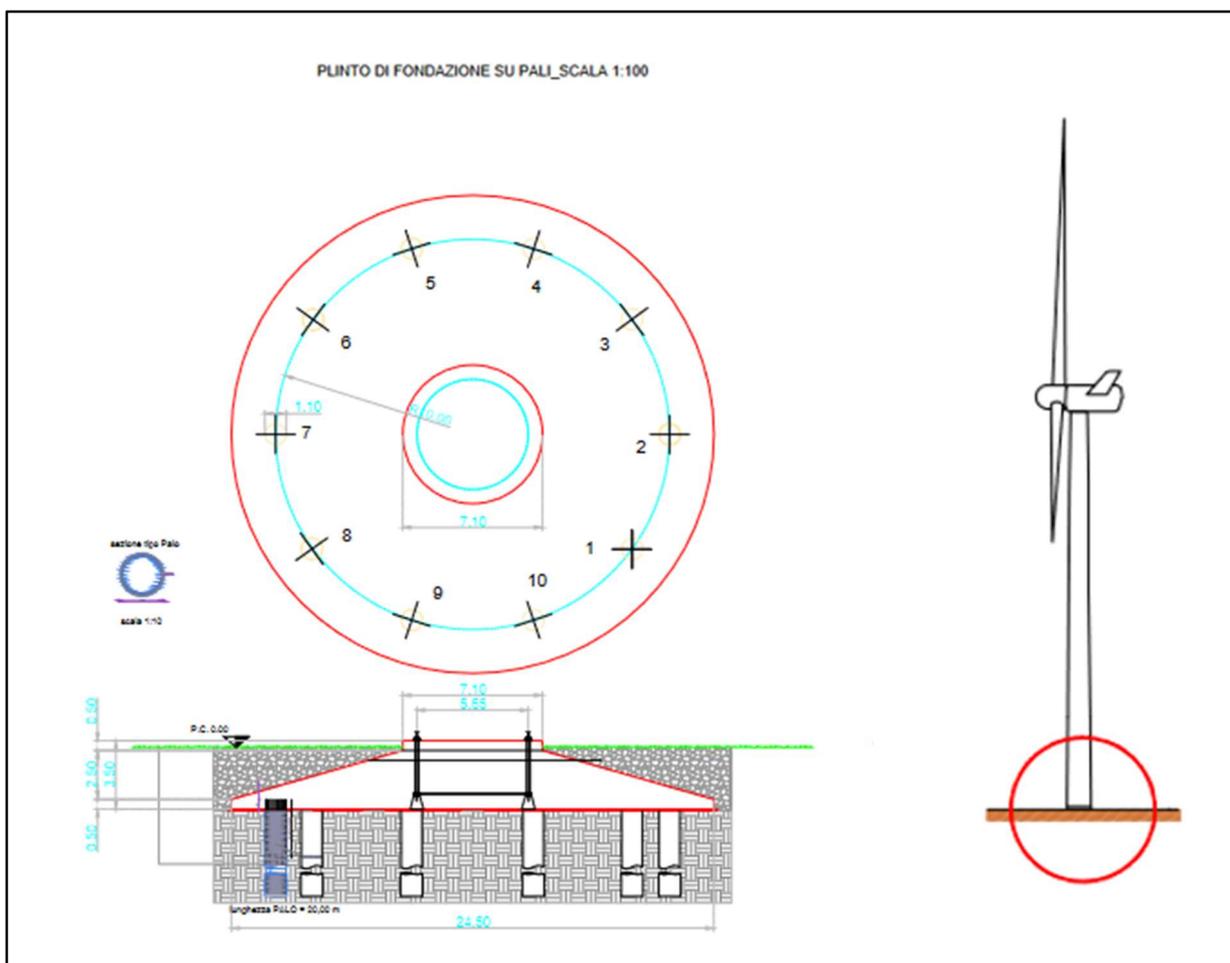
Dettaglio pianta e sezione fondazione
